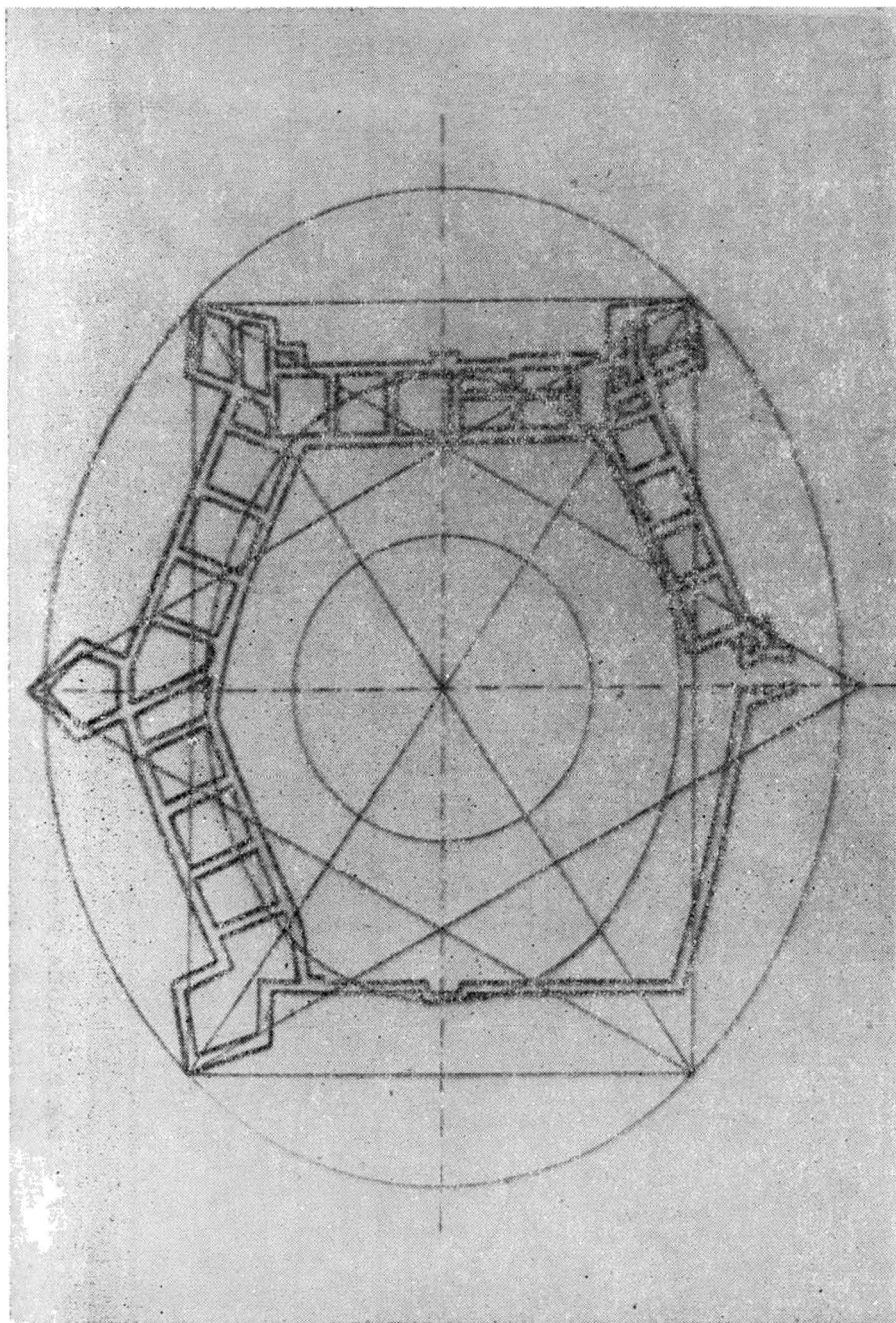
VINȚUL DE JOS, Reconstituirea concepției planimetrice a castelului.
